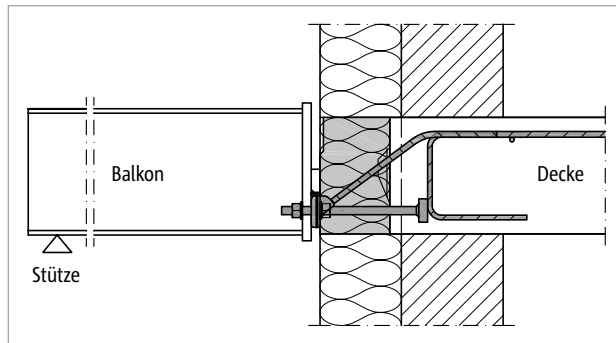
Schöck Isokorb® XT Typ SQP: Dämmkörper schließt mit Hilfe des Deckenvorsprungs außen bündig mit der Dämmung der Wand ab, dabei sind die seitlichen Randabstände zu beachten
